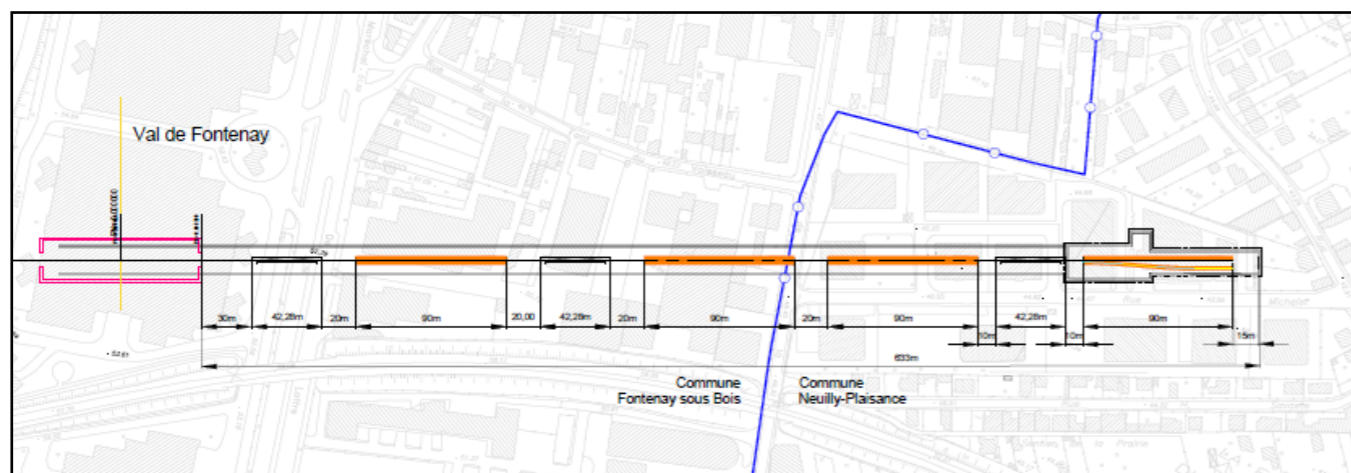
Plan des voies du CDT entre Val de Fontenay et le CDT (Source : RATP)
